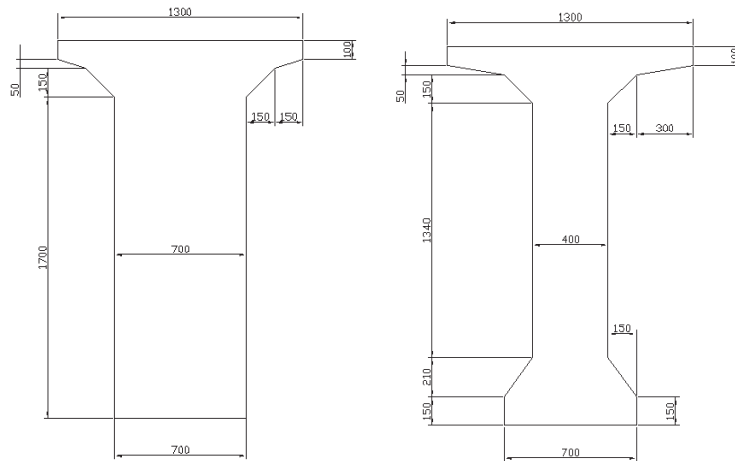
Section poutre (zone d'about et zone médiane)
